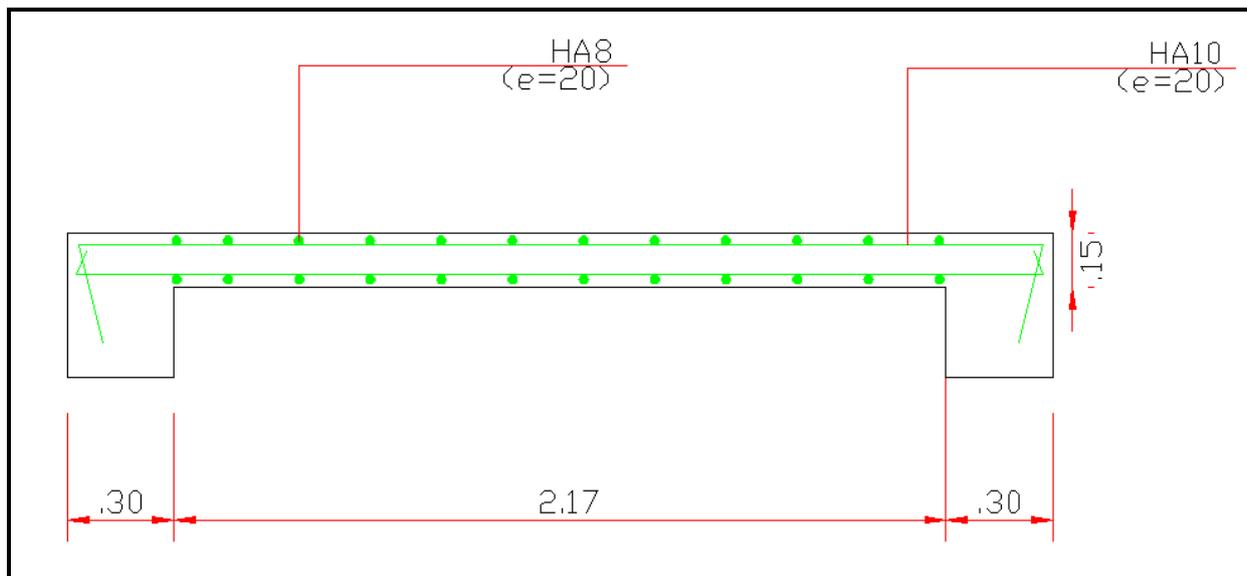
ferrailage balcon 02 (coupe A-A).
